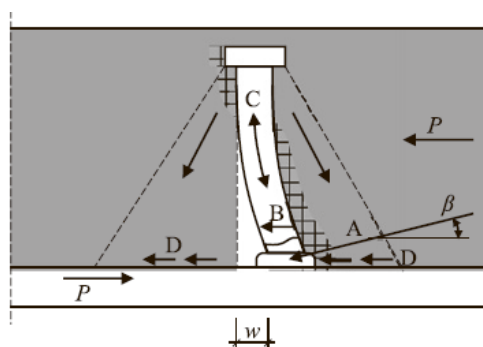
Модель Лунгера для описания НДС стержневого анкерного упора в составе сталежелезобетонного перекрытия с плитой, устроенной по плоской опалубке [132]
